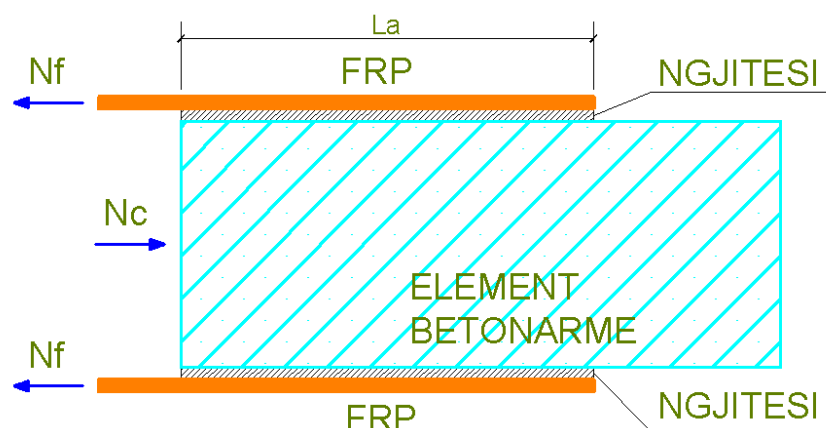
Prova e lidhjes (aderencës) FRP – beton
